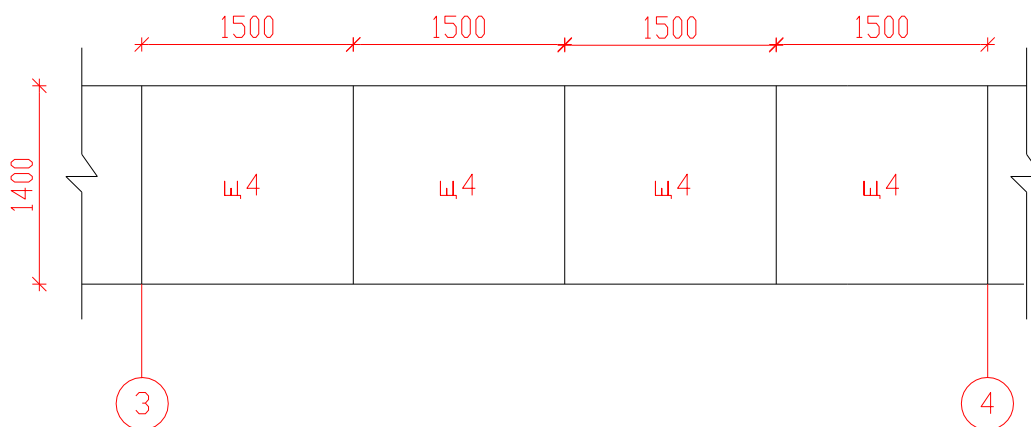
Схема розкладки щитів стрічкового фундаменту
